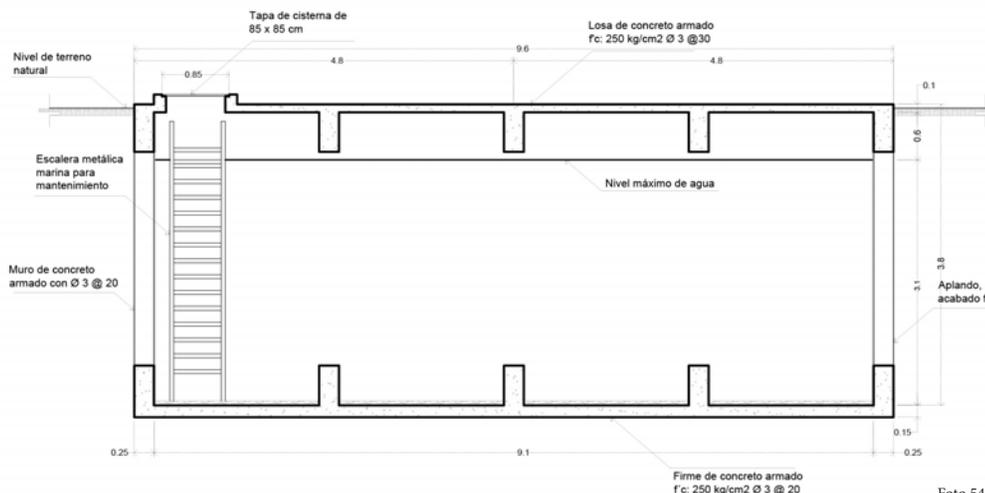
Detalles técnico de cisterna. Para mayor detalle ver plano IH-09
